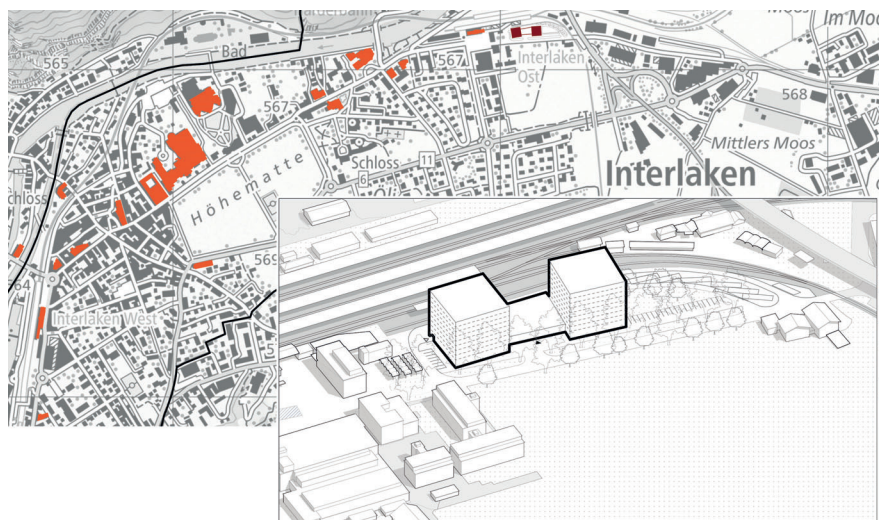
Einpassung ins Ortsbild, Vergleich mit anderen Hotelbauten
